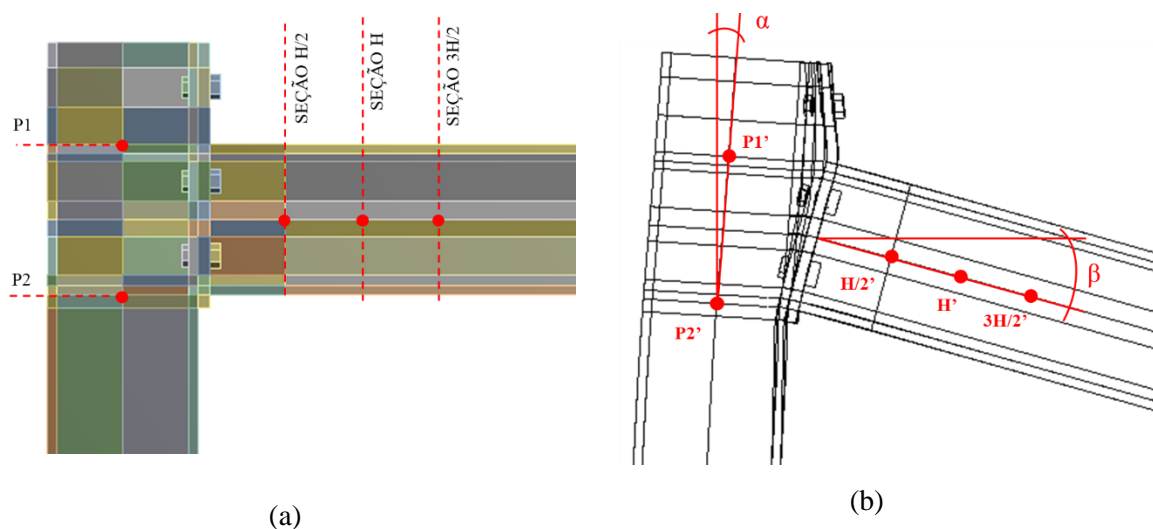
Medição da rotação da ligação: (a) posição dos pontos da estrutura não deformada e (b) pontos nas posições deformadas
